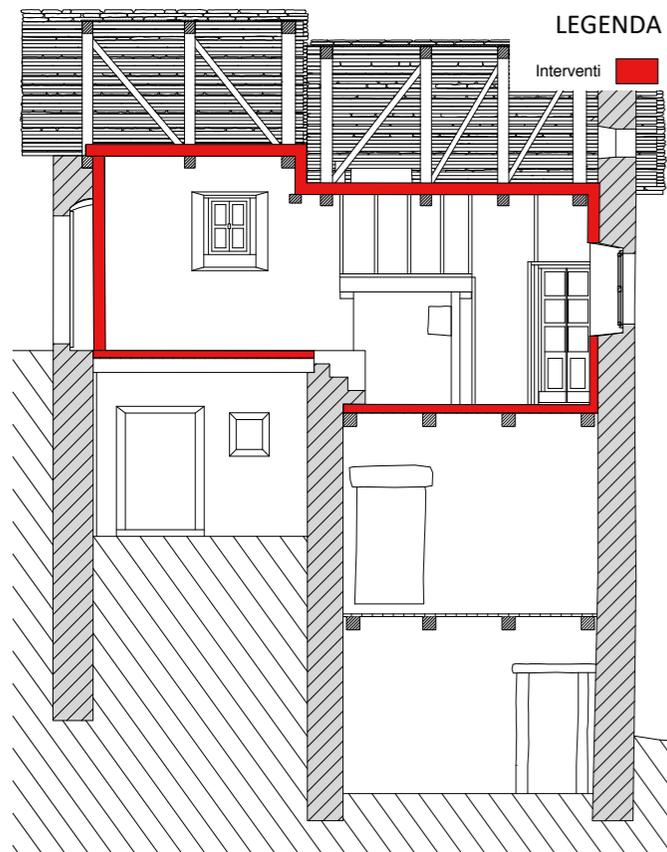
Evidenziazione interventi in sezione longitudinale.
